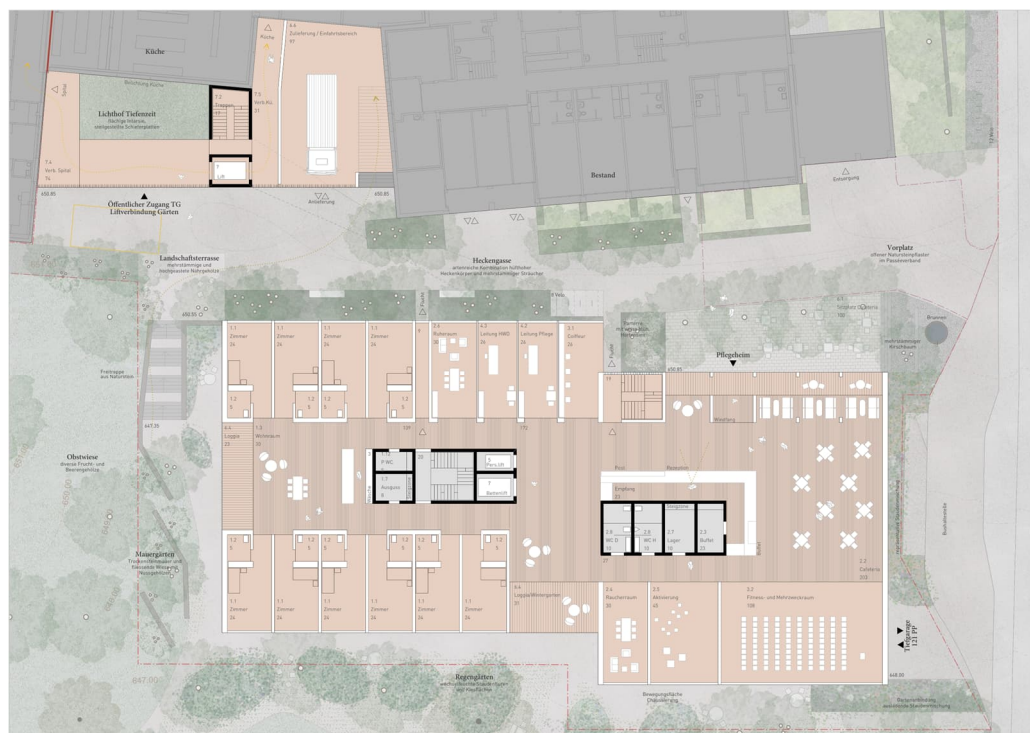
Grundriss Erdgeschoss Domino (massstabslos)
